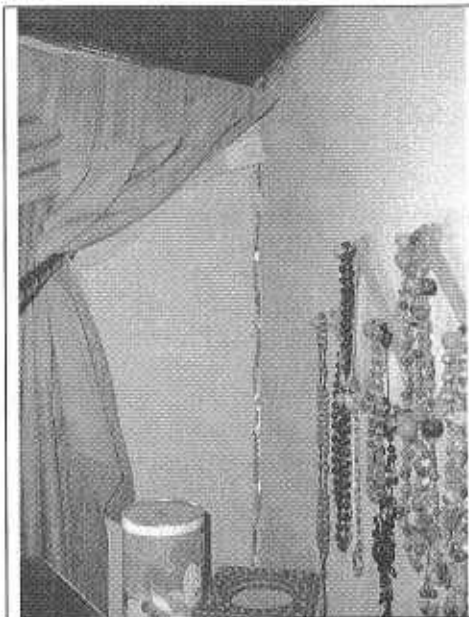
Grieta de tendencia vertical en el punto de contacto entre los muros de la ampliación (izquierda) y la construcción original (2° nivel).
